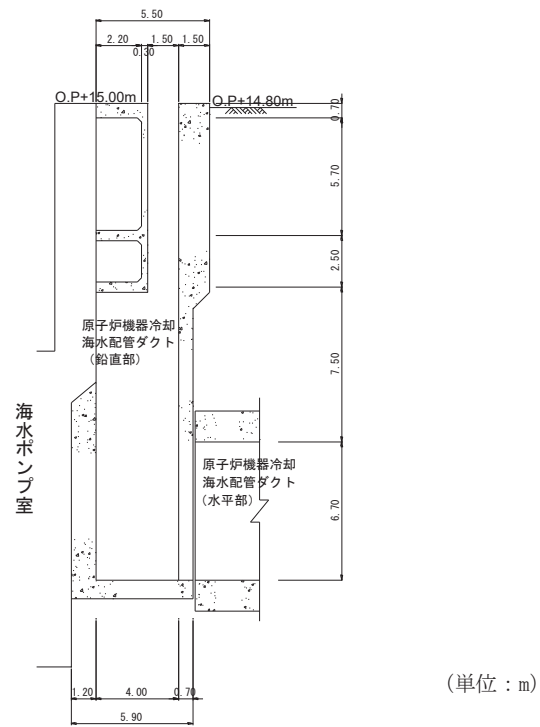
原子炉機器冷却海水配管ダクト (鉛直部) 縦断面図 (A-A 断面)
